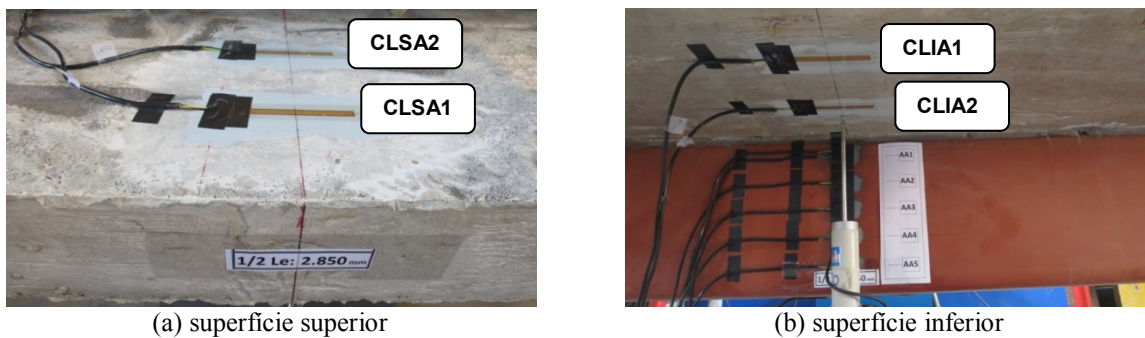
Ensaio de flexão: instrumentação da laje
